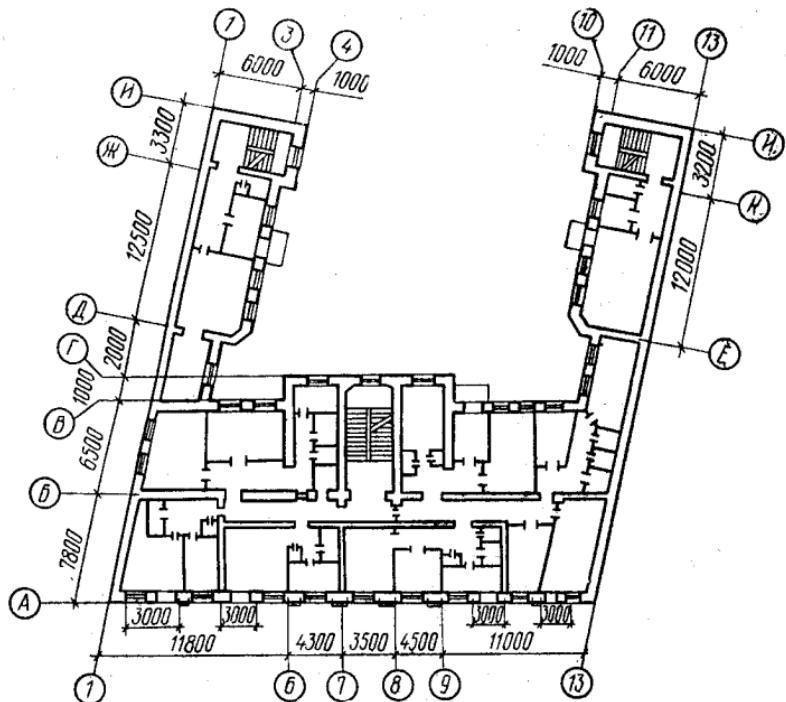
План перепланировки типового этажа реконструируемого дома (г. Харьков)
